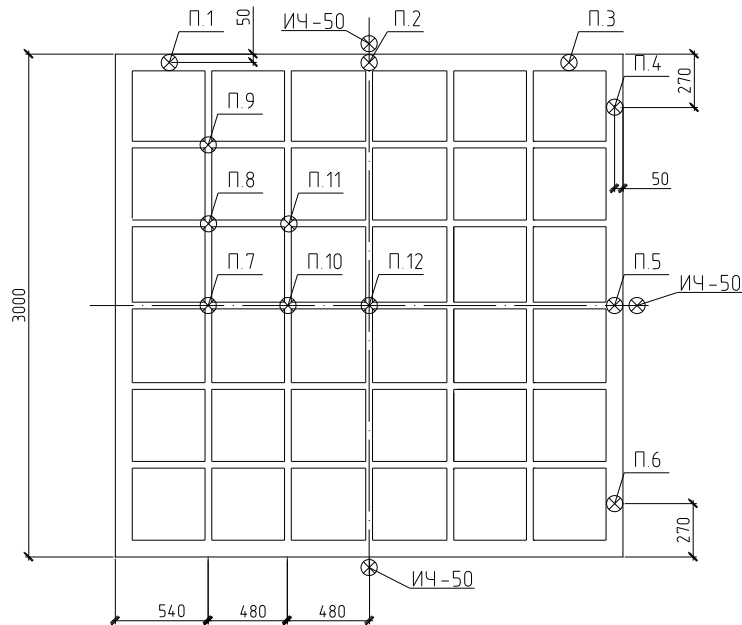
Нижняя поверхность конструкции. Схема расстановки индикаторов и прогибомеров часового типа
